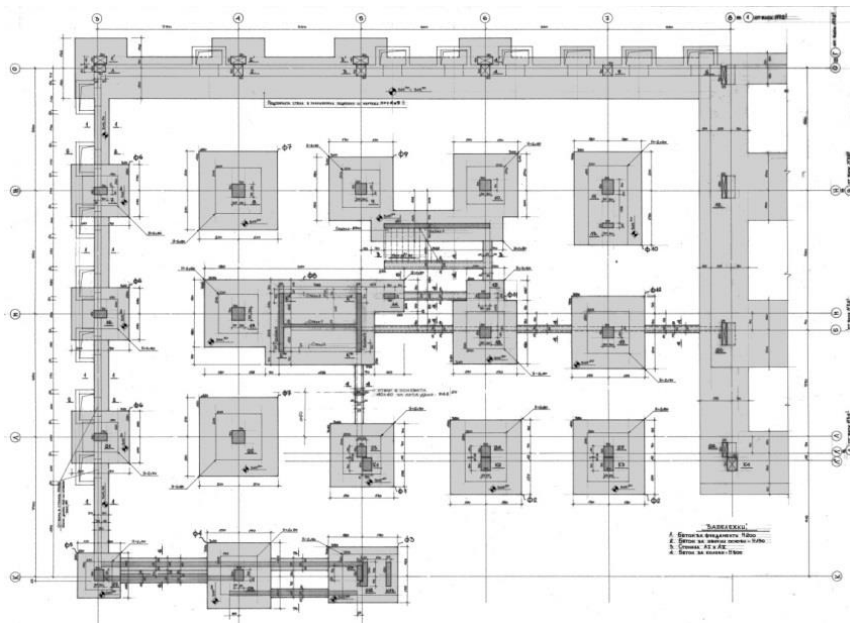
Арморовъчен план – рамка на амфитеатъра на блок 4 на УАСГ
